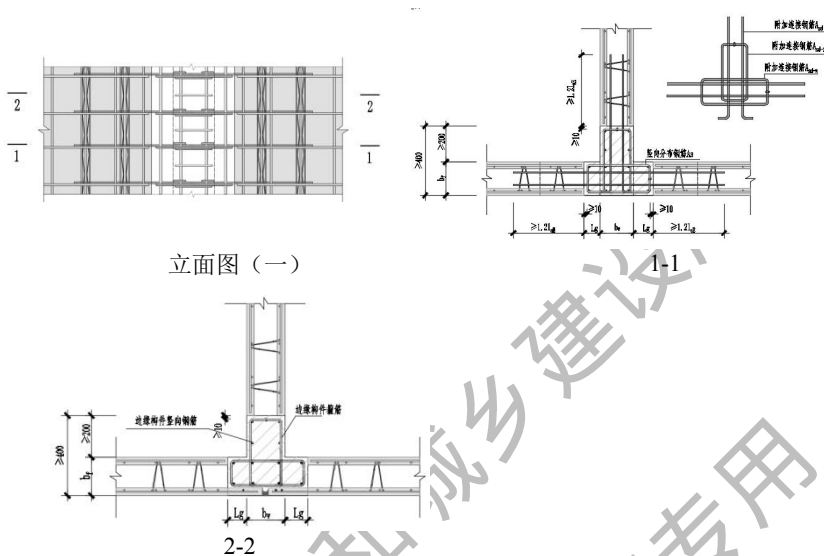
预制双面叠合剪力墙肢与 T 型构造边缘翼墙的水平连接构造
